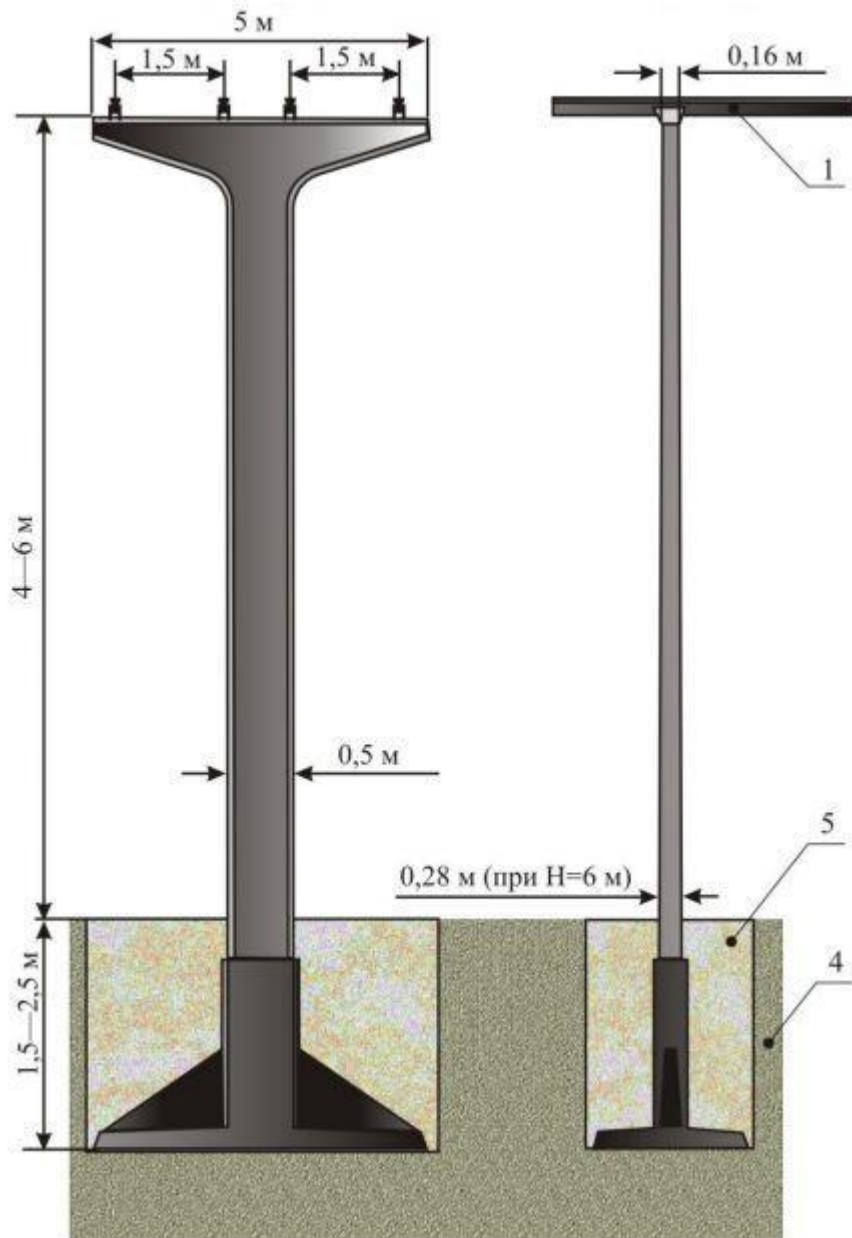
Поддерживающая железобетонная опора двухпутной трассы СТЮ колеей 1,5 м на плитном фундаменте: 1 – рельс-струна; 2 – опора; 3 – фундамент; 4 – земля; 5 – выемка грунта.
